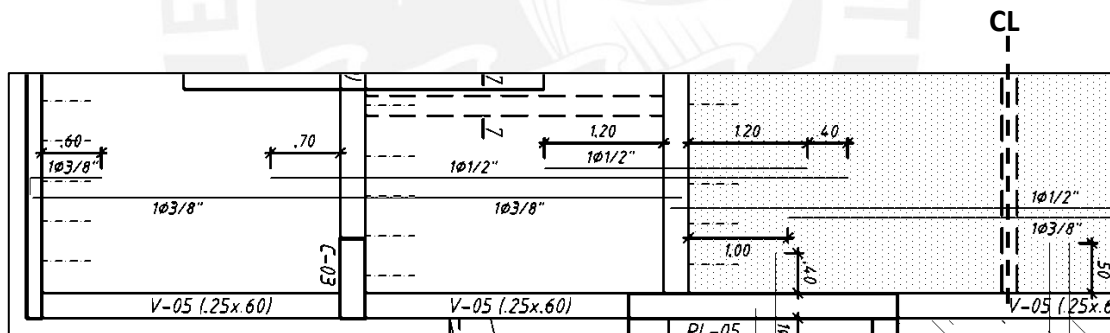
Distribución final del refuerzo en la losa aligerada analizada.
